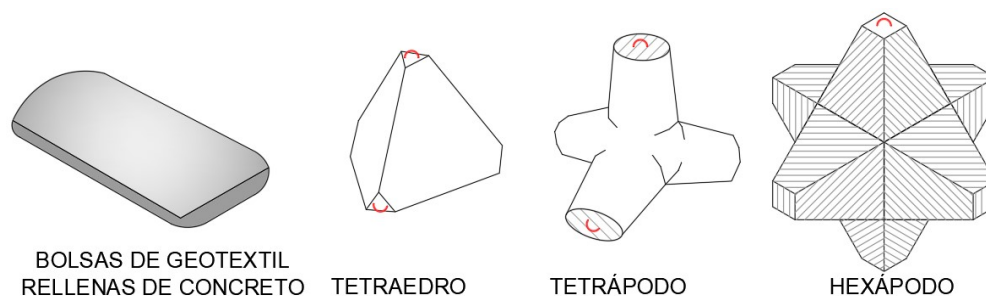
Tipos de enrocado artificial o prefabricados en concreto
